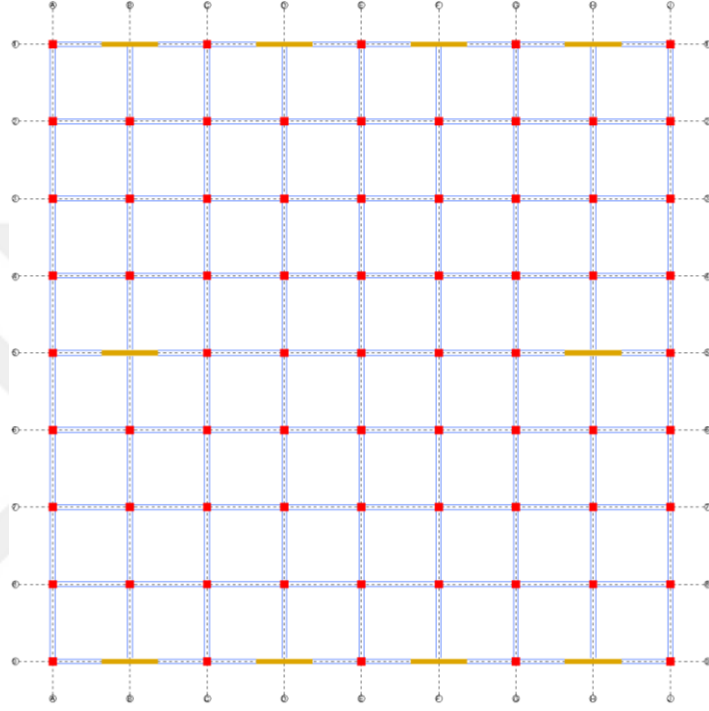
Model 7.2 'ye Ait Kat Planı
